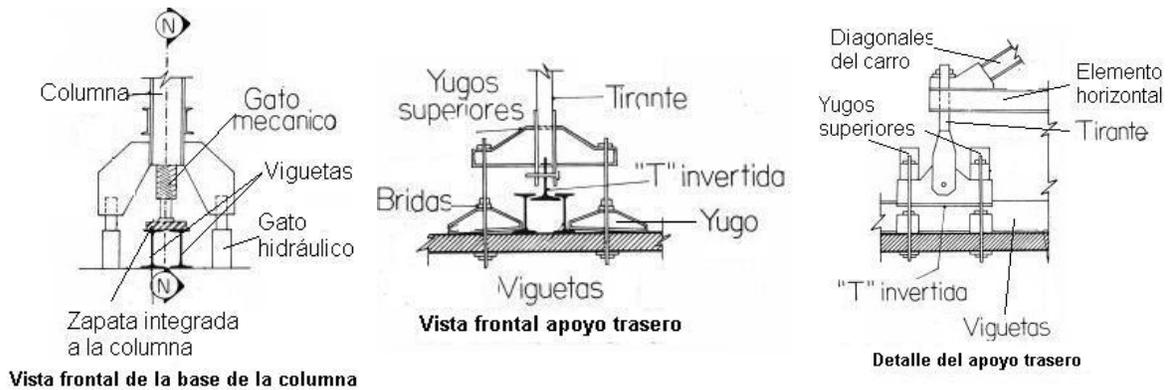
Dispositivo de anclaje de las columnas del carro.
